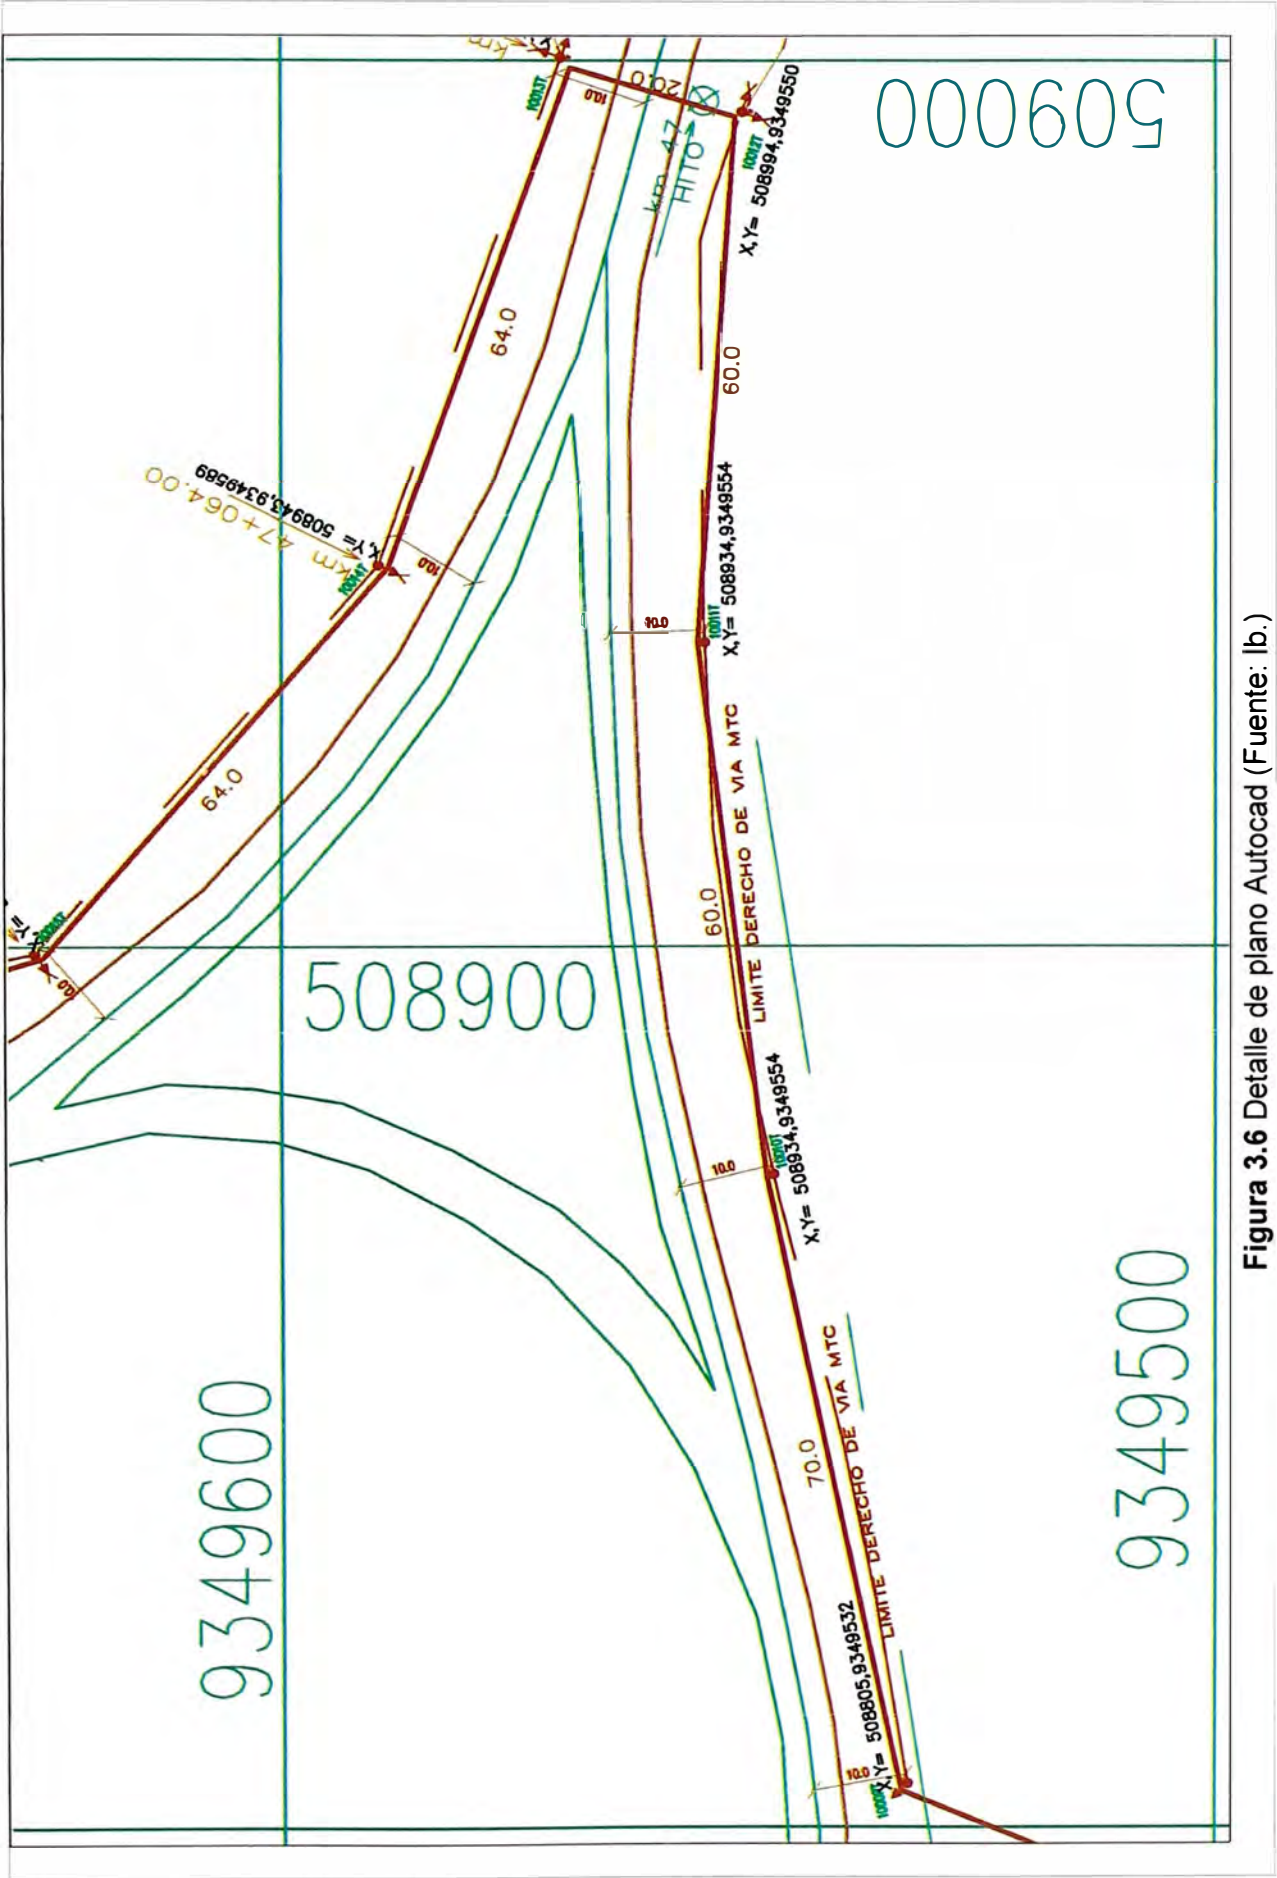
Detalle de plano Autocad (Fuente: lb.)
